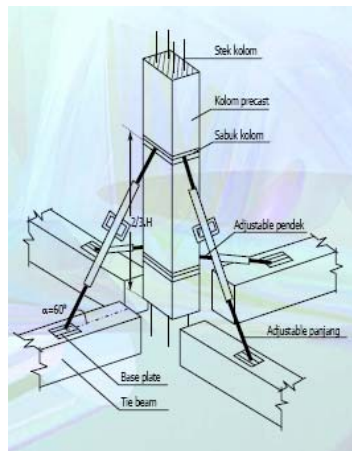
Sistem Struktur Pracetak JEEDS(Pertemuan Balok–Kolom)
